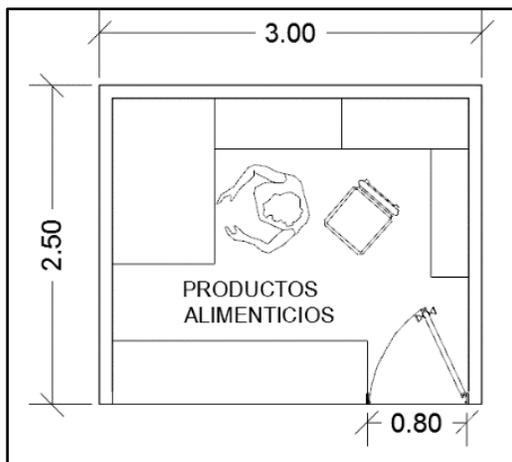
propuesta distribución en planta PRODUCTOS SECOS SIN ESCALA
